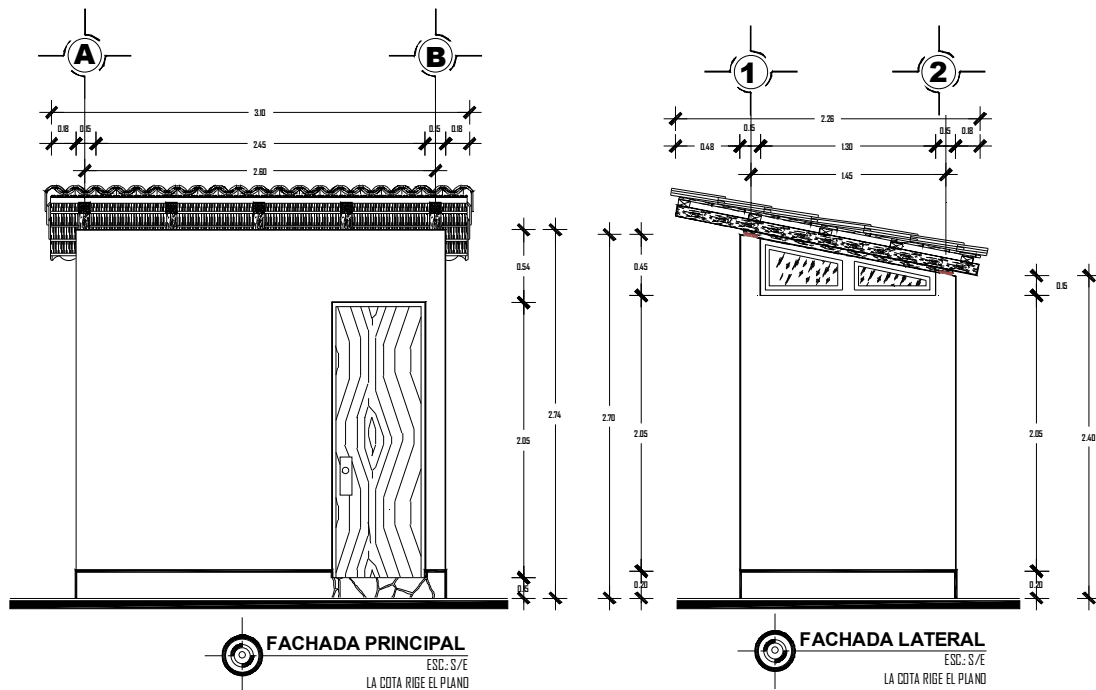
Fachada principal y fachada lateral del cuarto de baño.
